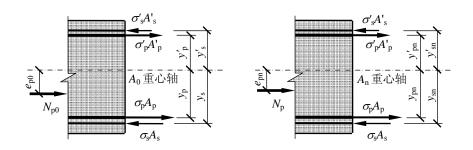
配有预应力钢筋和非预应力钢筋的受弯构件截面 (a) 先张法构件;(b) 后张法构件
